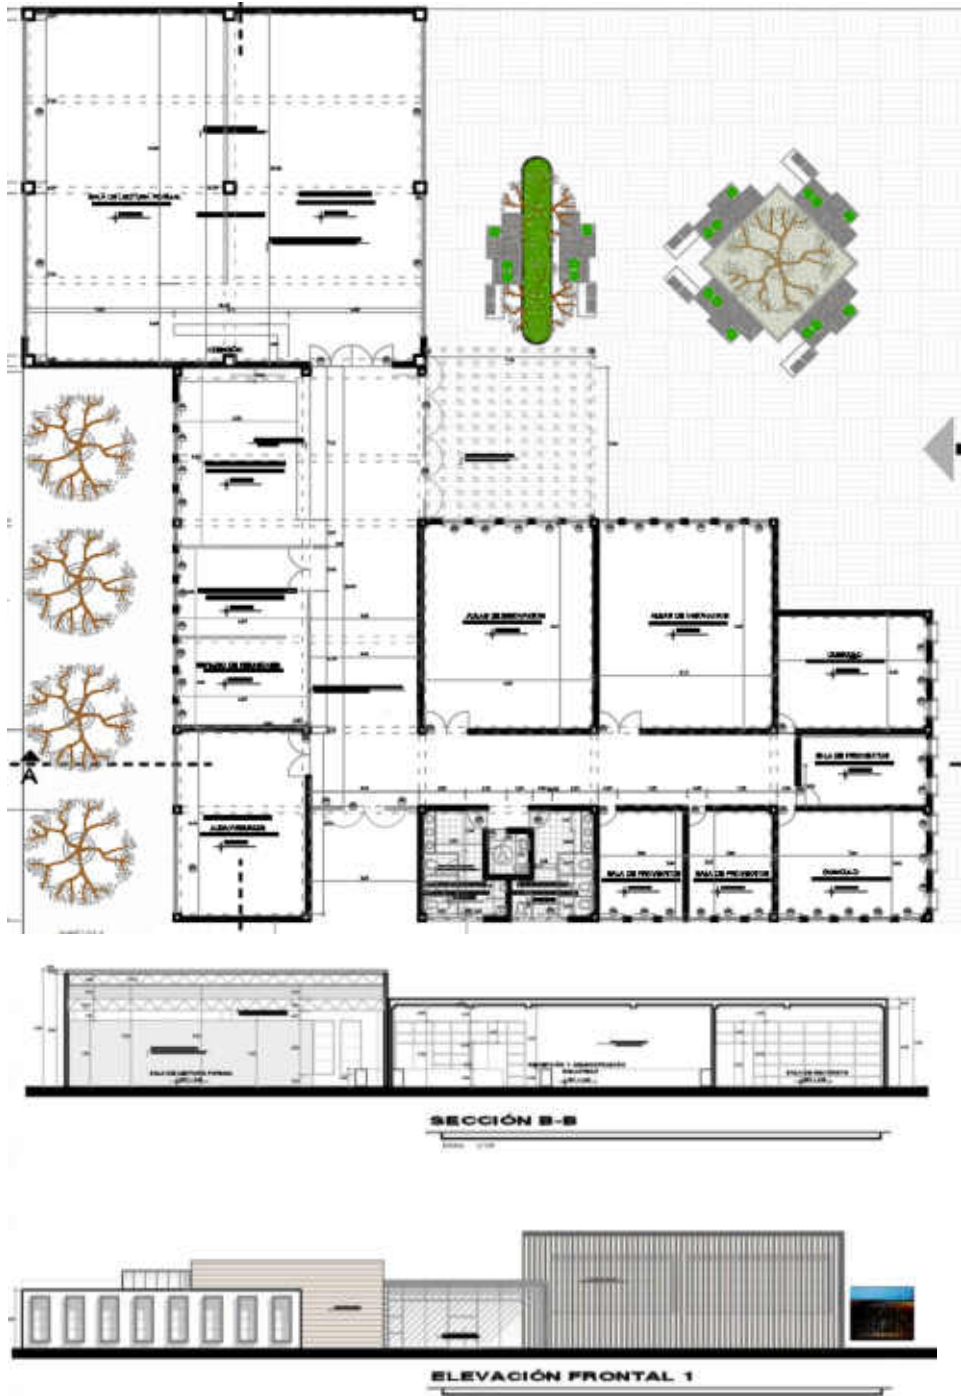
planta y secciones de bloque de biblioteca, fuente elaboración propia.
